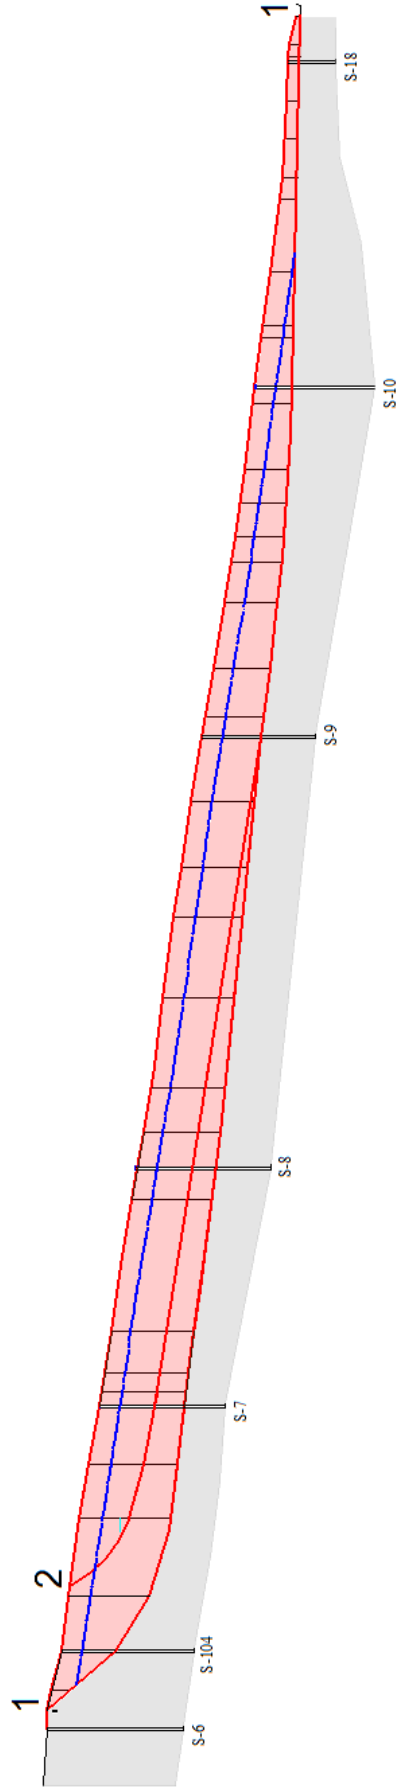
Schema de calcul pentru determinarea stabilității versantului pe terenul nr.3 din orașelul Codru
